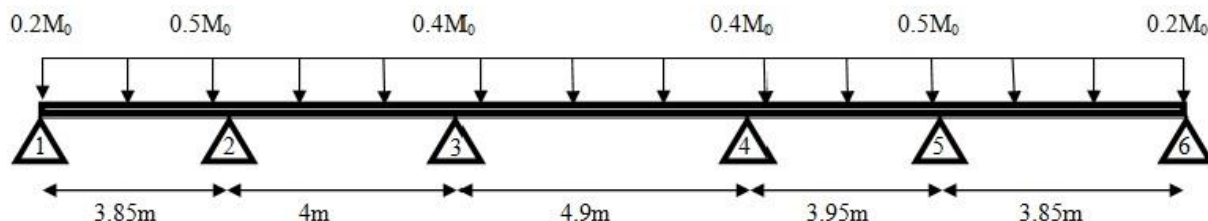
Schéma statique de poutrelle (1er type terrasse).
